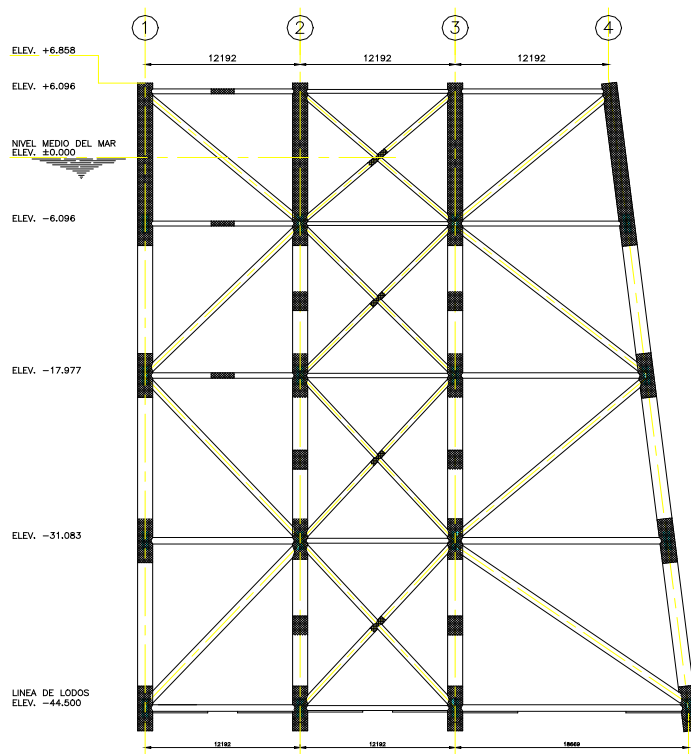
Elevación de Subestructura encargada de transmitir las cargas a los cimientos o pilotes.
